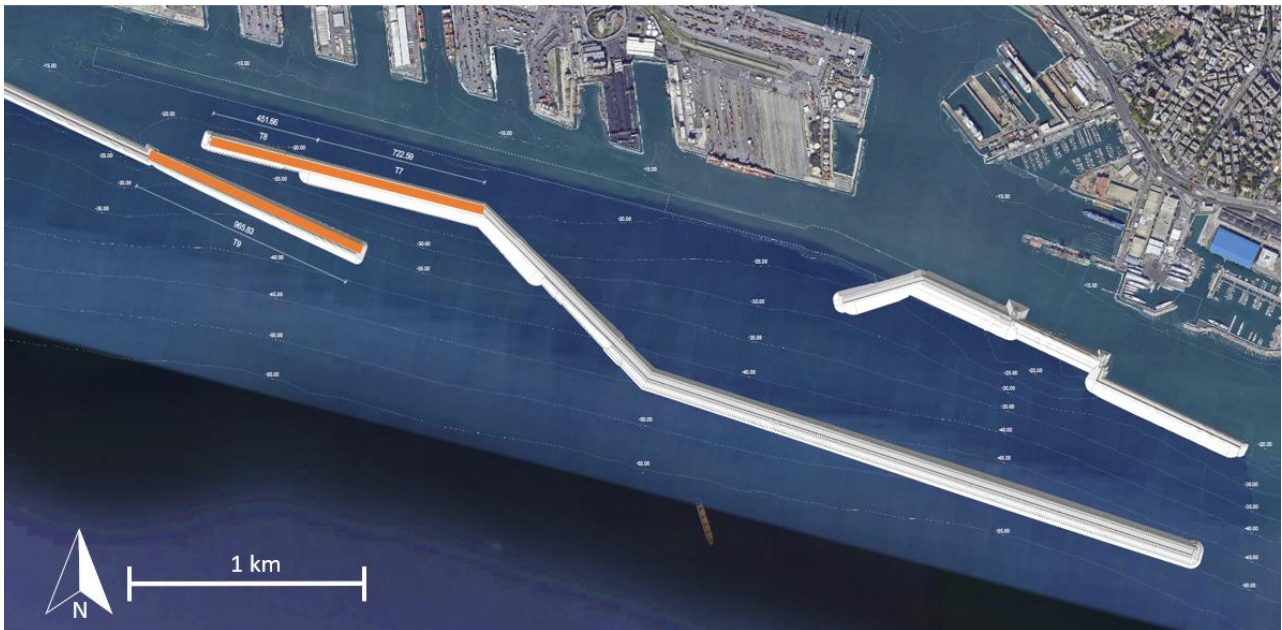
Planimetria di progetto - In arancione le aree interessate dalle attività previste nella Fase B
